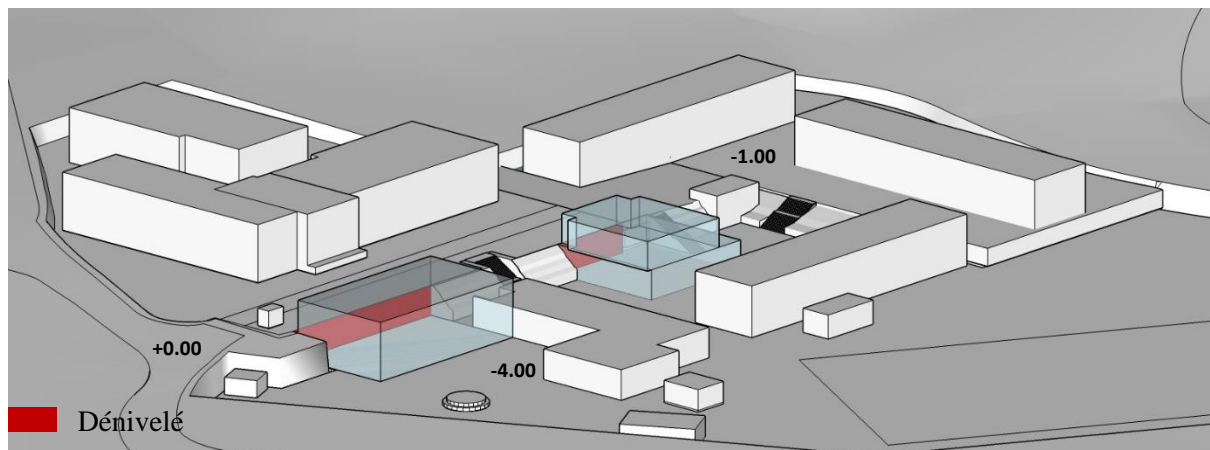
Vue 3D sur les différentes banquettes du site
